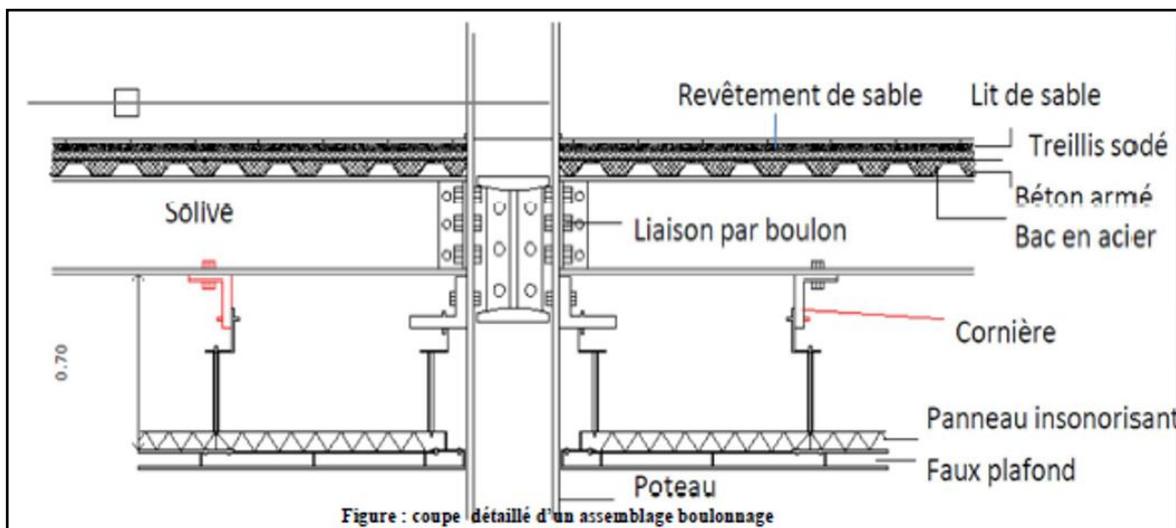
Assemblage poteau, poutre, plancher et faux plafond
